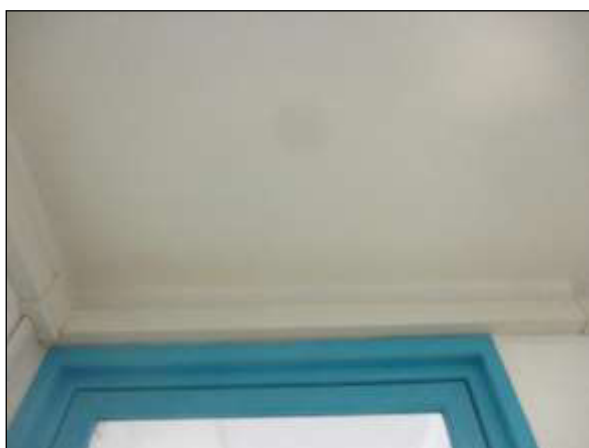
Porzione dell'intradosso del solaio del Corridoio al piano primo connotata da un concreto rischio di crollo.
